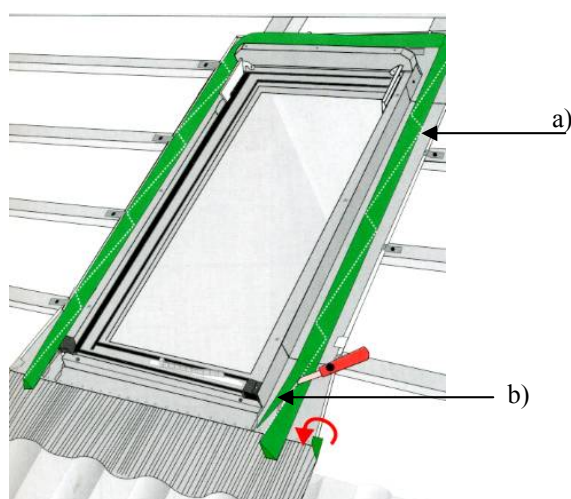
Montaż bocznych elementów kołnierza: a) montaż kołnierza, b) montaż pasków [5, s. 150].
